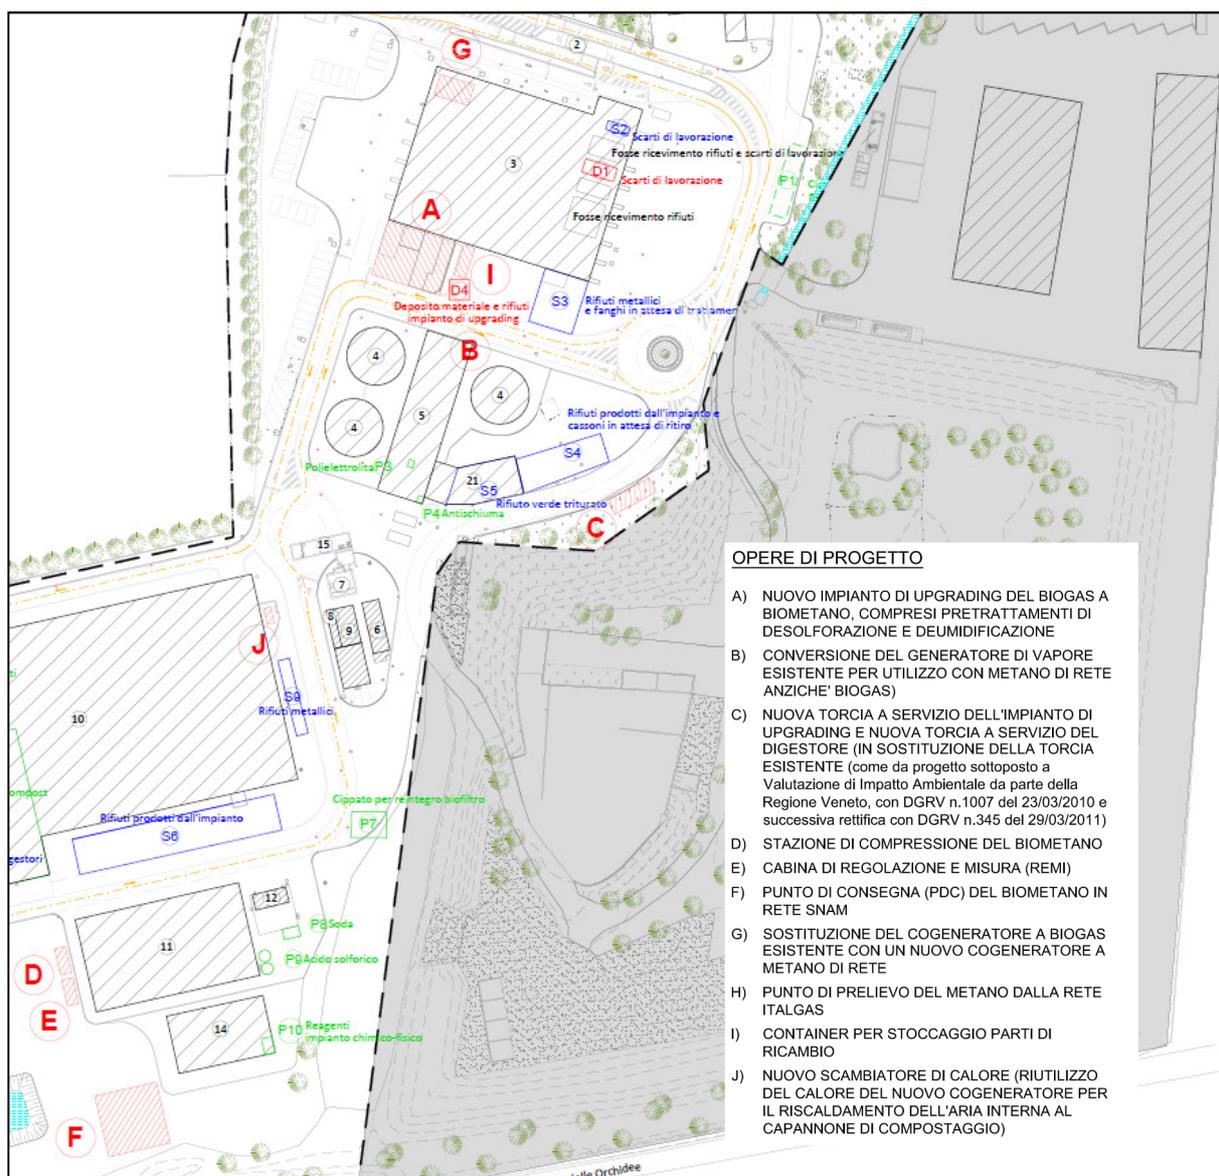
Estratto delle Tavole di progetto con localizzazione dell'impiantistica di progetto per il biometano
